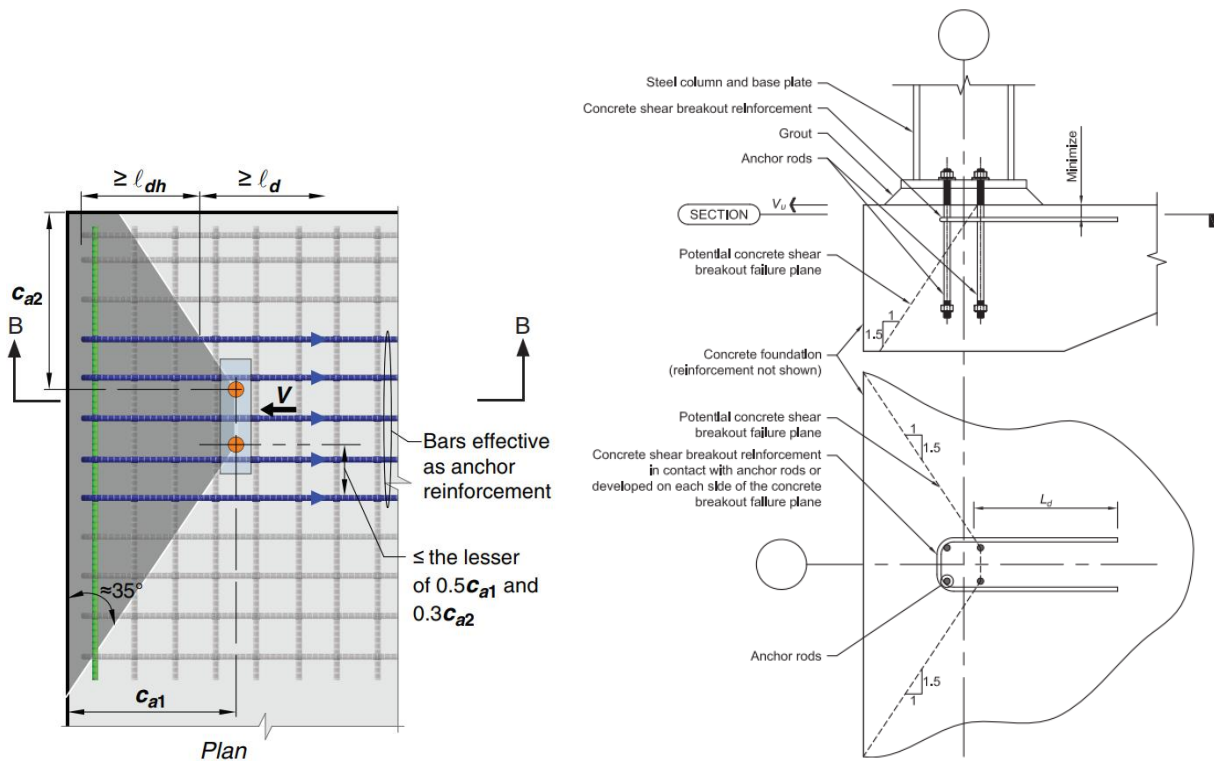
Uso de armadura de acero para corte (Fuente: Figura R17.5.2.1b *ACI 318* y 4-12 *AISC Desing Guide 01*).
